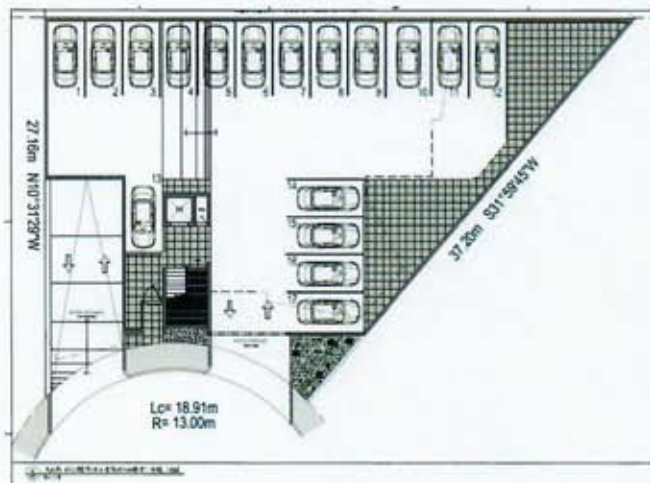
Planta arquitectónica nivel de calle.¹⁰⁰
